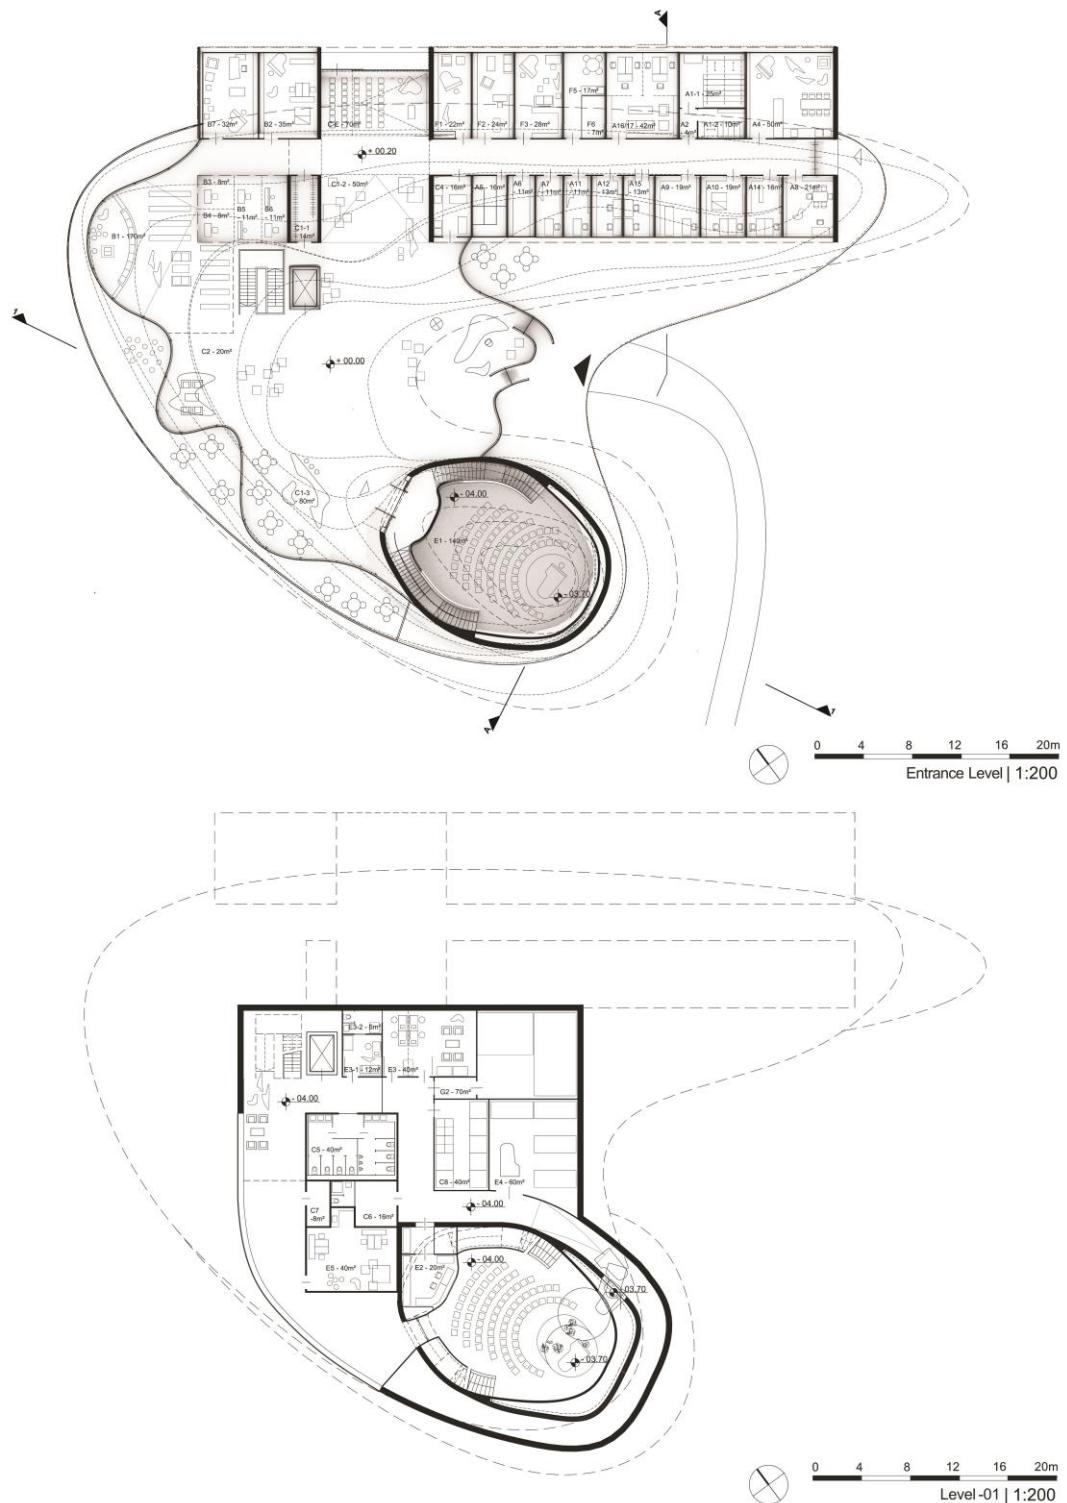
Extrait de la 4e planche rendu, plan du rez et du niveau enterré
